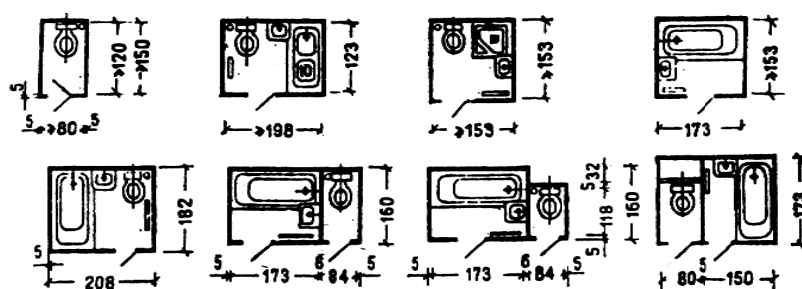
Приклади планування санвузлів (планувальні нормалі в см)
